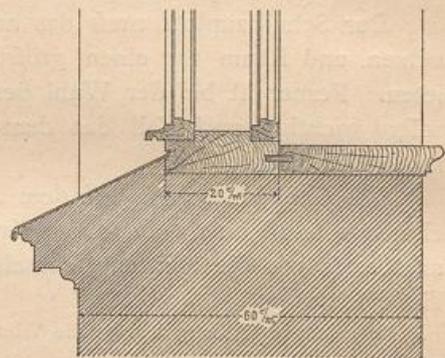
zeigt das Schema einer Fenster-Construction für Massivbauten.
